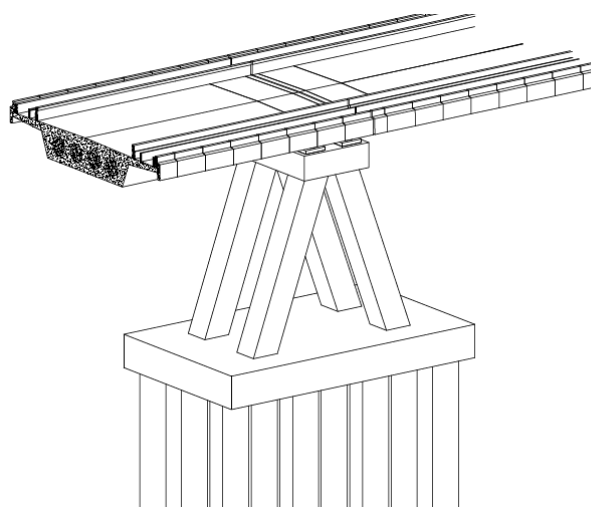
Vista de um pilar de junta em delta (imagem retirada do modelo BIM)
